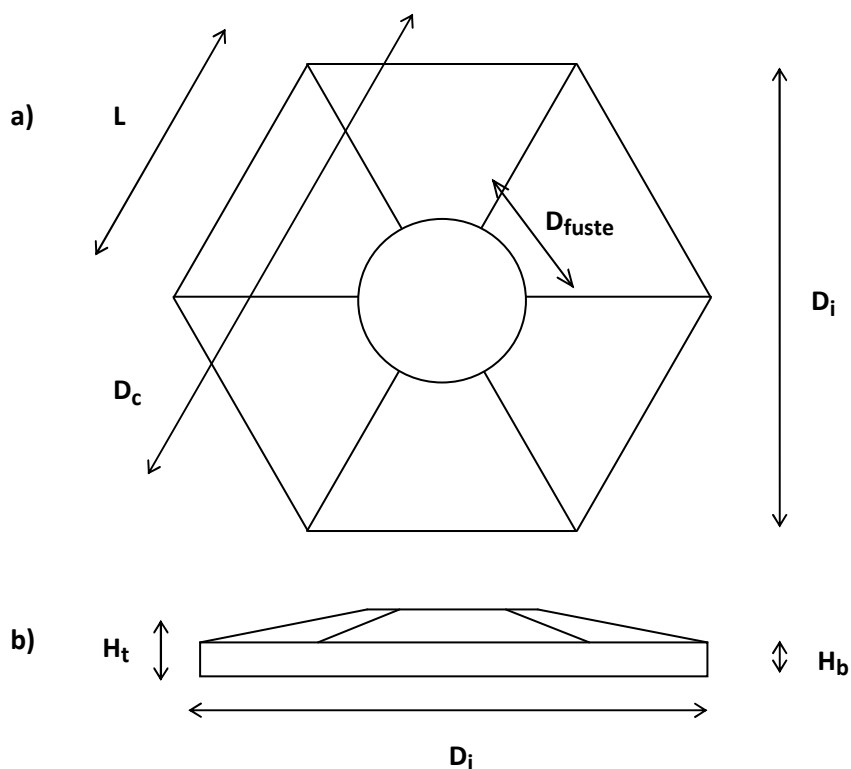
Zapata hexagonal: a) vista en planta, b) vista en alzado.
